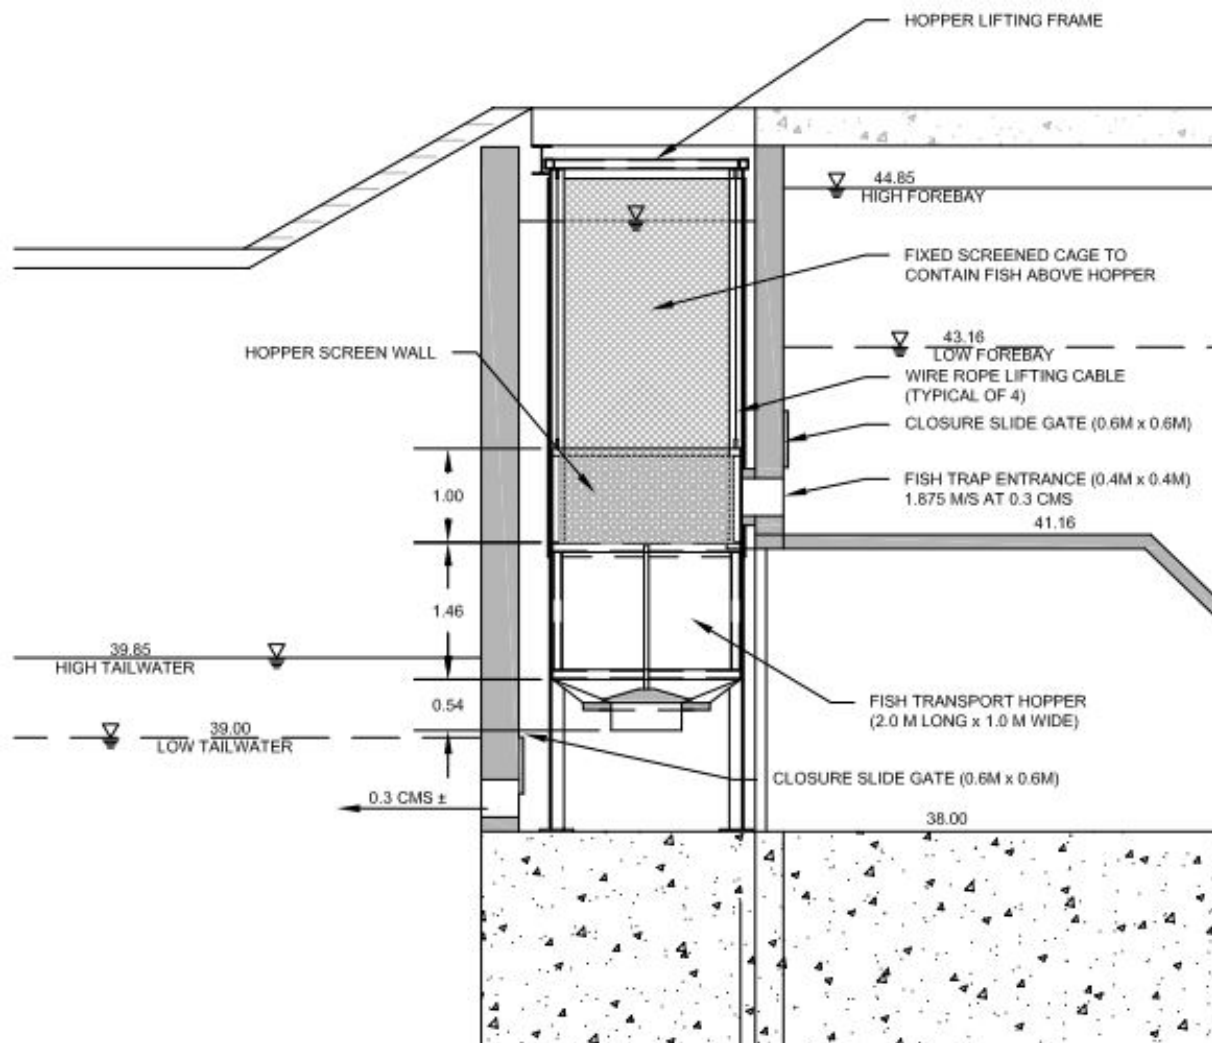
Planvy på uppsamlings och avvattningsanordningen placerad i det kilformade utrymmet från Figur 14 och 15.
